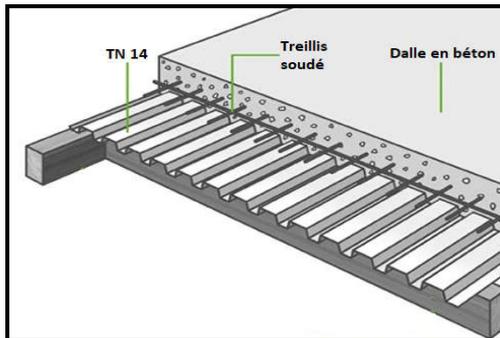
Plancher collaborant. Source : leroymerlin.fr
